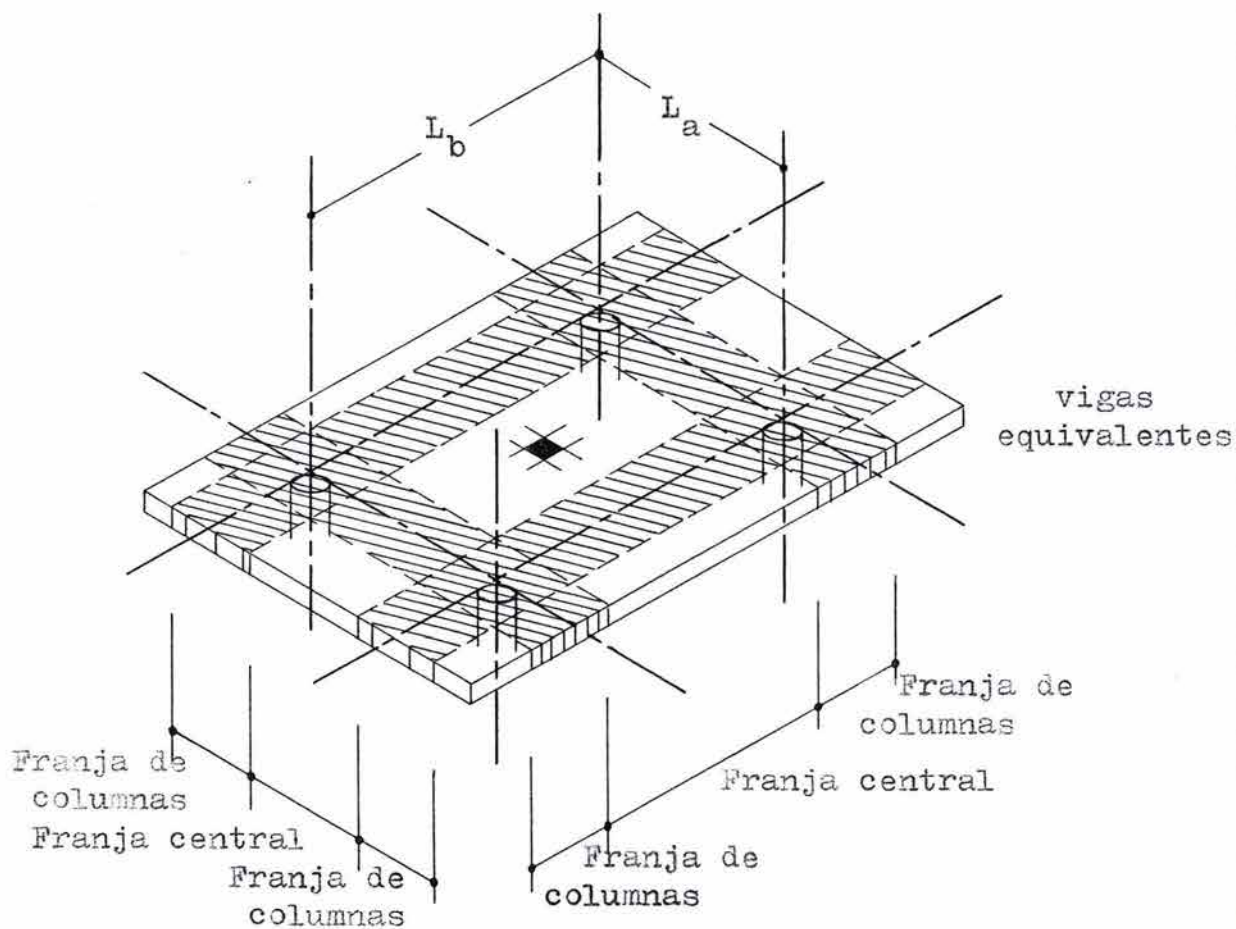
SISTEMA DE PISO DE LOSA PLANA CON REFUERZO EN DOS DIRECCIONES INDICANDO LAS VIGAS EQUIVALENTES.
